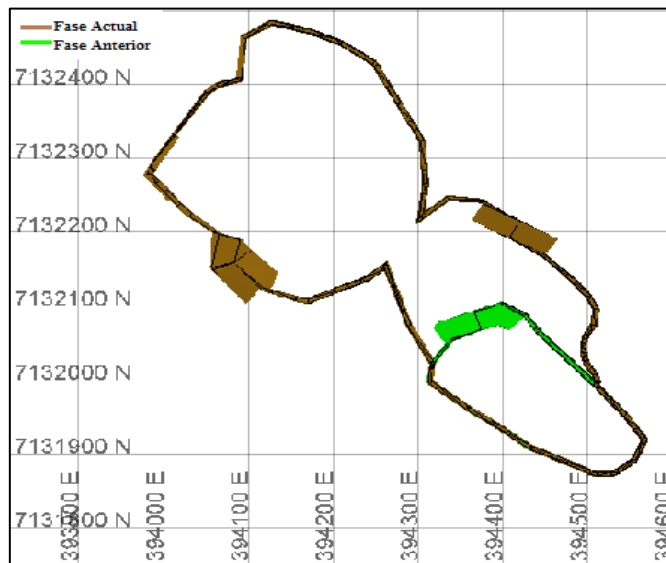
LPNB Fase 4 - Vista en sección - Planta banco 1110
